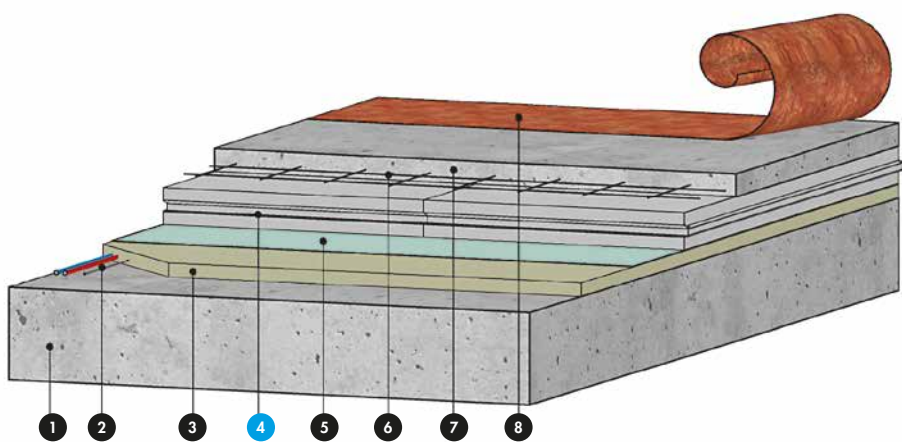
Mise en œuvre sous chape hydraulique et isolant rainé bouveté ou feuilluré 4 côtés
